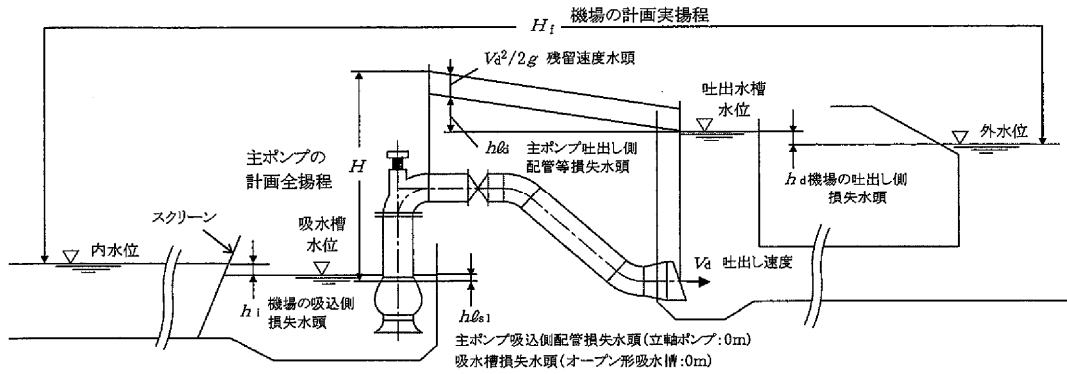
揚程模式図 [揚排ポンプ基準 第4章 第1節 第2項]
